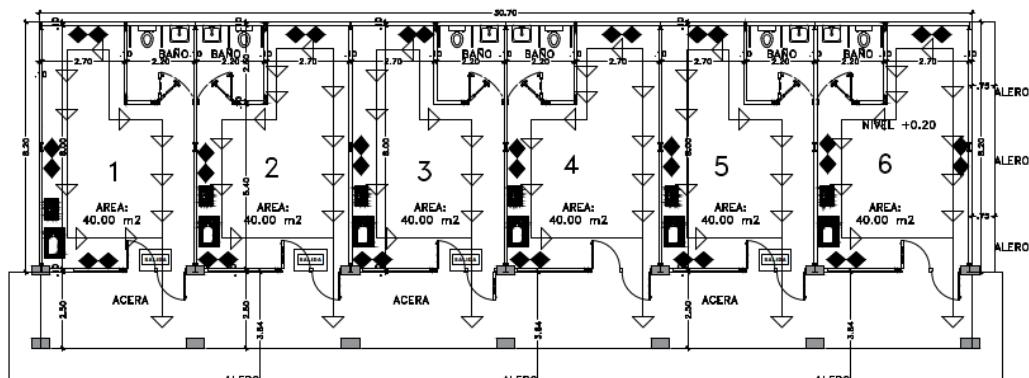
Planta arquitectónica Módulo C. Fuente: Plano del proyecto
